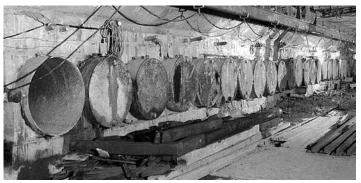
アンダーピーニング適用パイプルーフ施工完了状況
